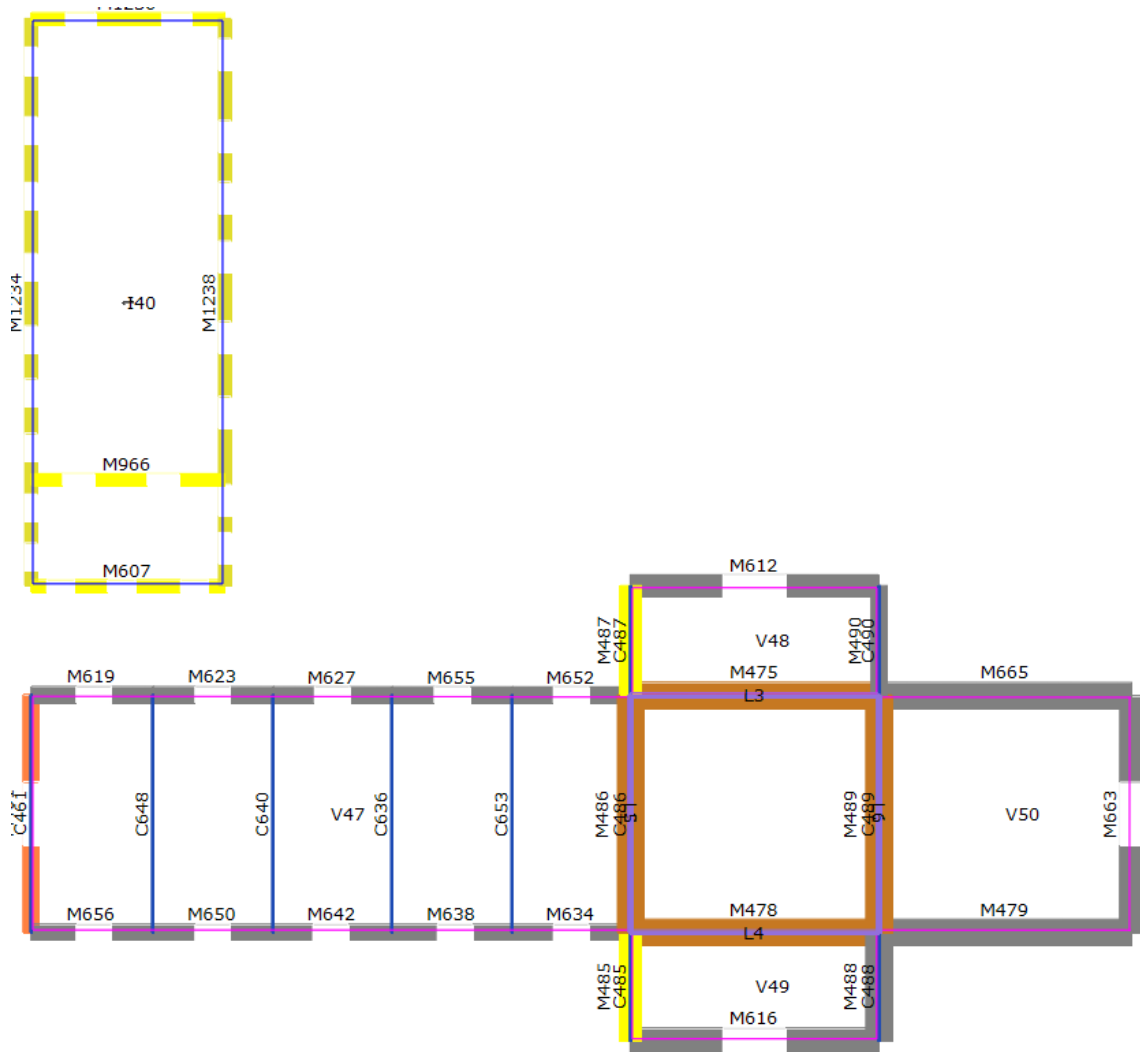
Planimetria livello 4 (15.70 – 18.90 m).
